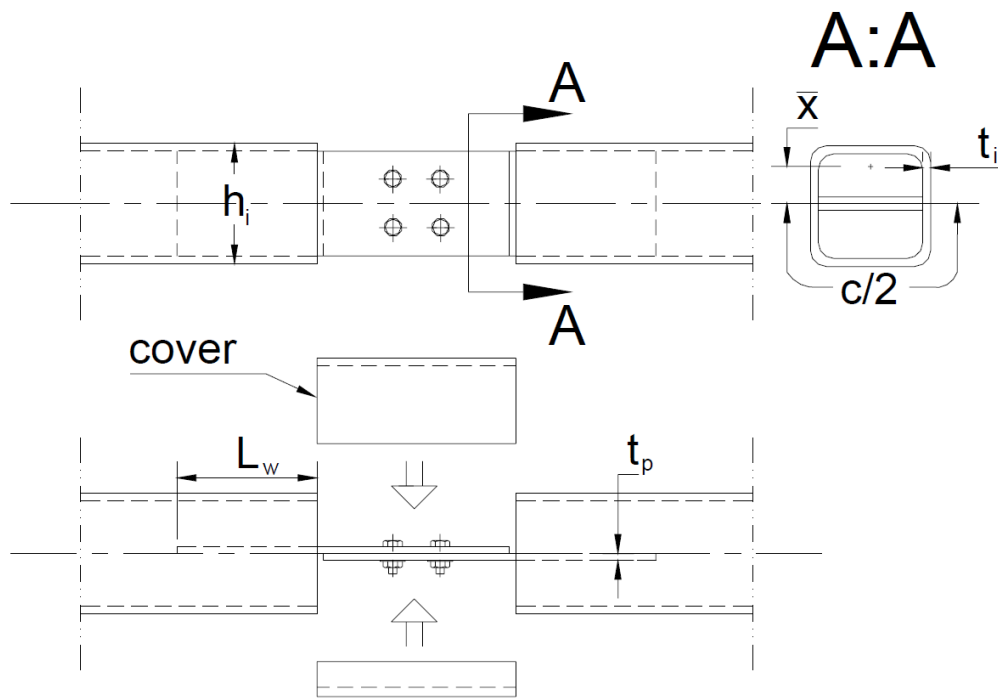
Nus amb dues plaques soldades en les cares del RHS.
